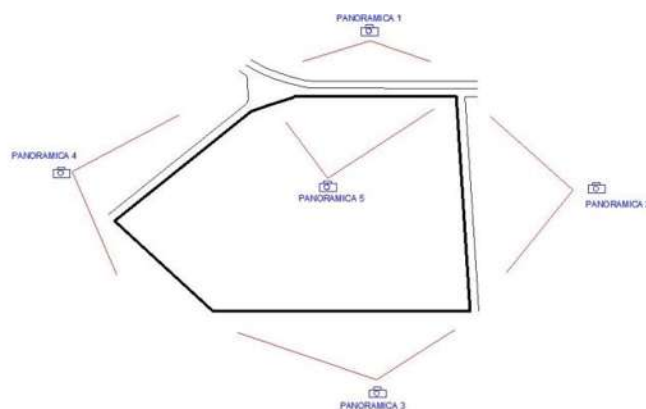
, CROQUIS DEL TERRENO. J.A.R.O.
